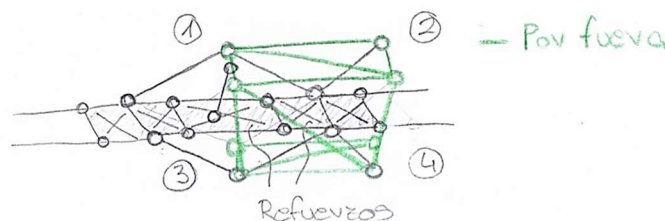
Detalle de piezas de la guía empleando barras articuladas
